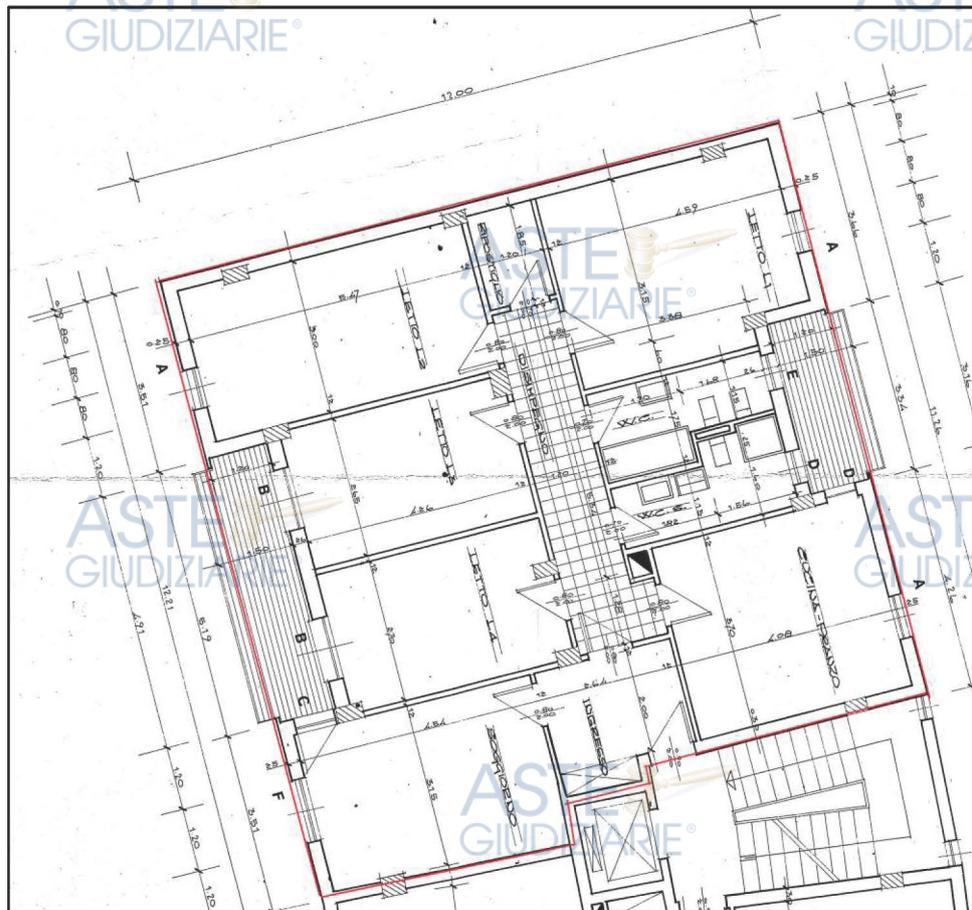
Stralcio della pianta dello stato autorizzato di progetto.
